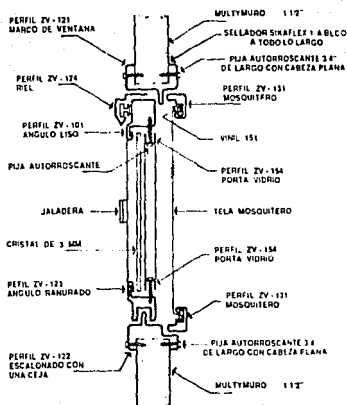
DETALLES CONSTRUCTIVOS (SOLUCIONES) DE MULTYMURO .
